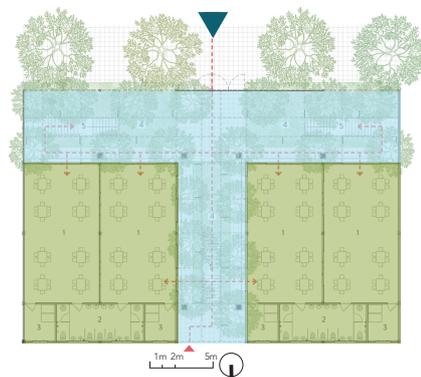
Emplazamiento e Implantación de My Montessori Garden Preschool
